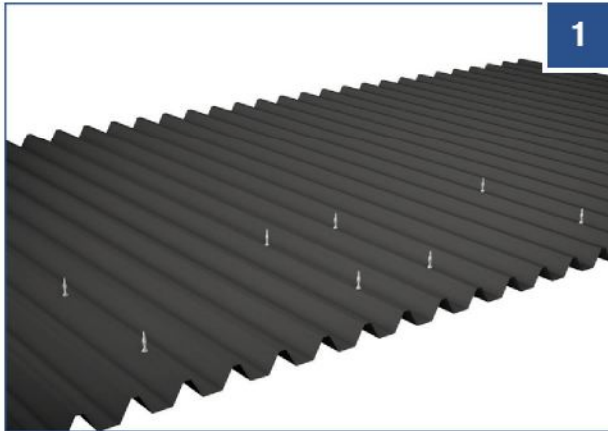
, 2: En primer lugar se colocan los tornillos de doble rosca en la construcción del techo. Las separaciones correspondientes se desprenden de los planos de montaje del proyecto.
